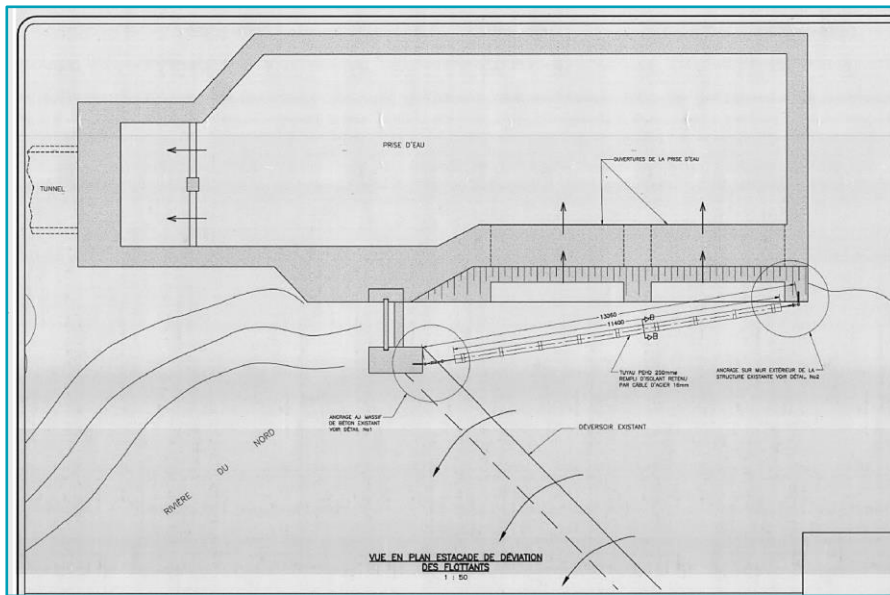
Schéma vu en plan du site de prélèvement, 24 juillet 2002
